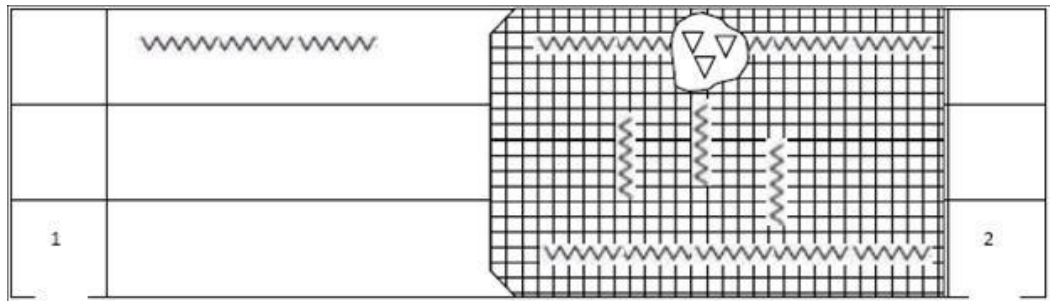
Levantamiento de daños de la viga secundaria parcialmente reparada (⊗), indicada en la Figura 9, mostrando fisuras (~~~~) y área lixiviada (Δ)
